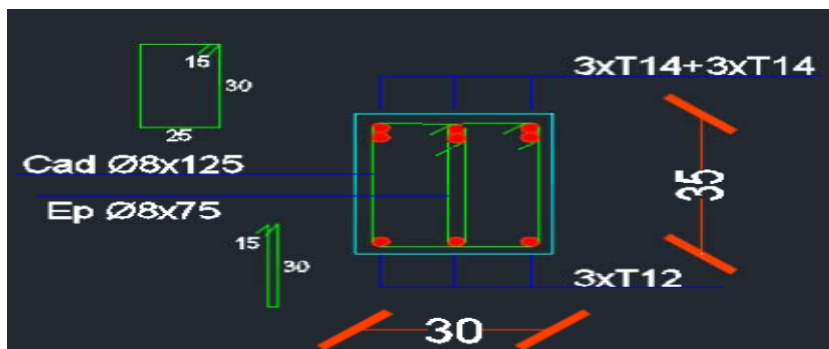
Ferrailage des poutres secondaires au niveau d'appuis
